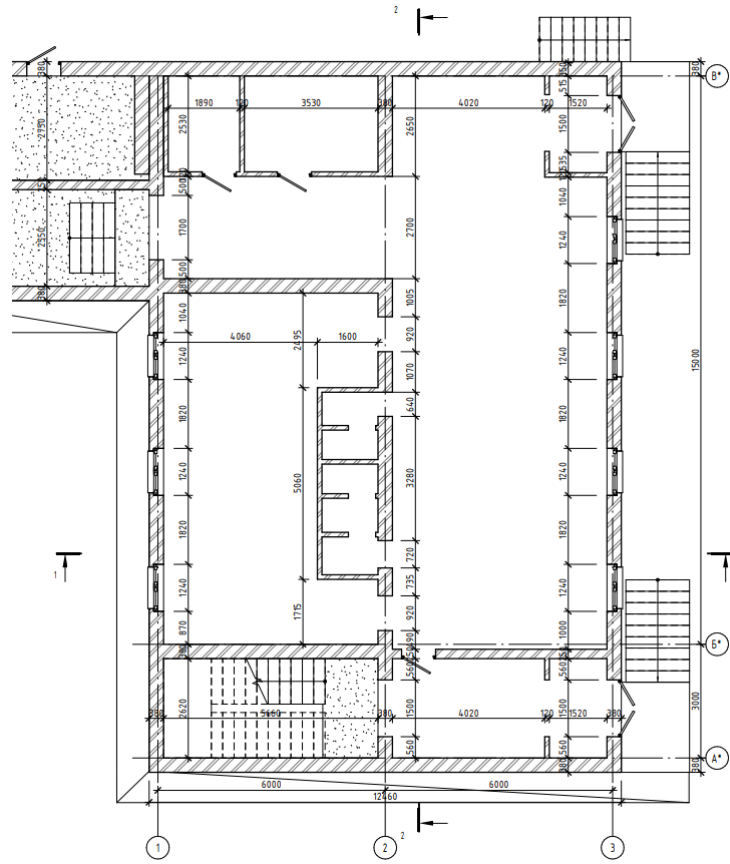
План 1-го поверху на відм. 0.00м
